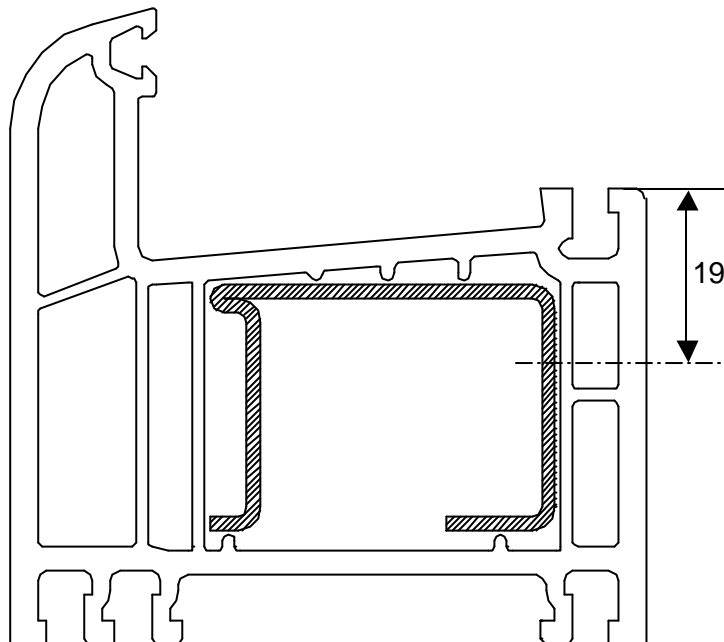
Profil EuroFutur, Fa. Kömmerling mit Beschlagsschraube „Power Duo“, geprüft als System V1
